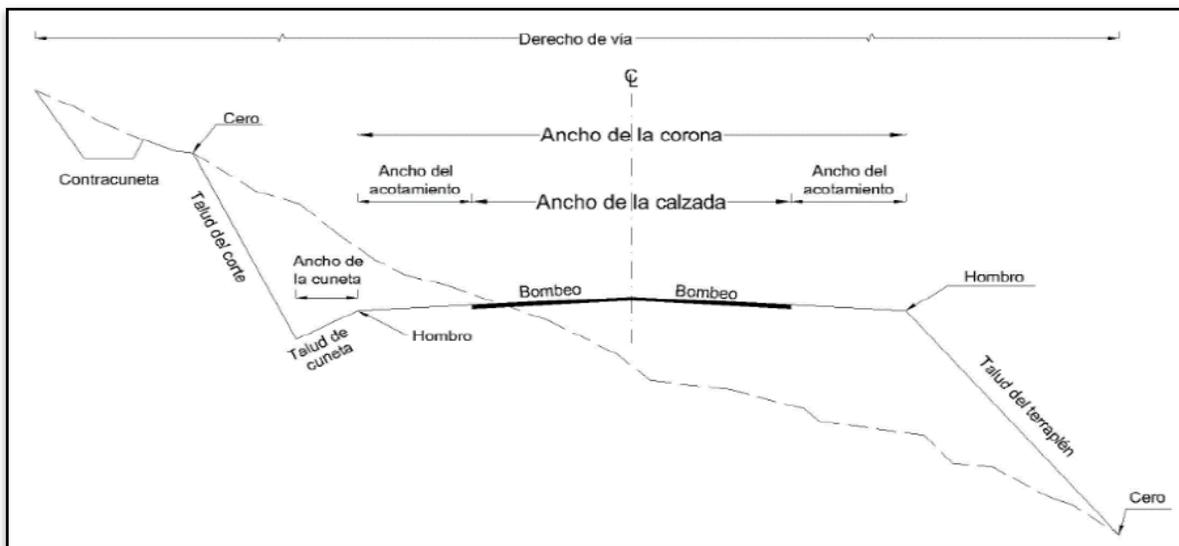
Sección transversal típica de carretera de dos carriles.
